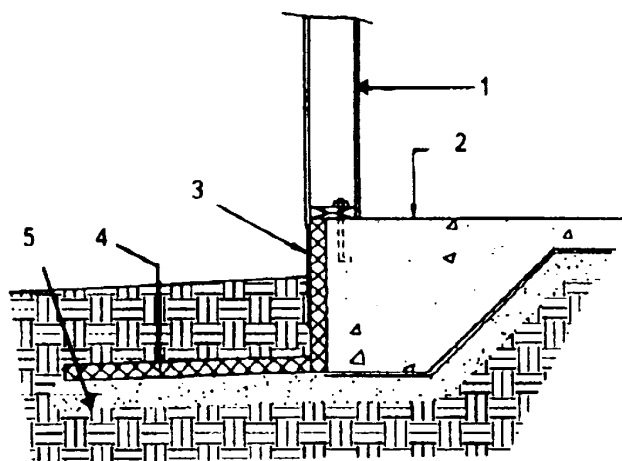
Конструкция мелкозалегающего фундамента для условий Финляндии:
